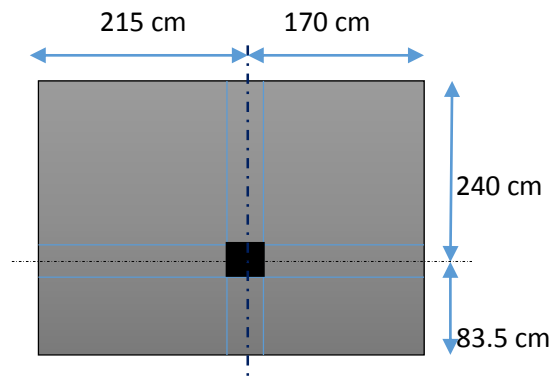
Surface de plancher reprise par le poteau le plus sollicité
